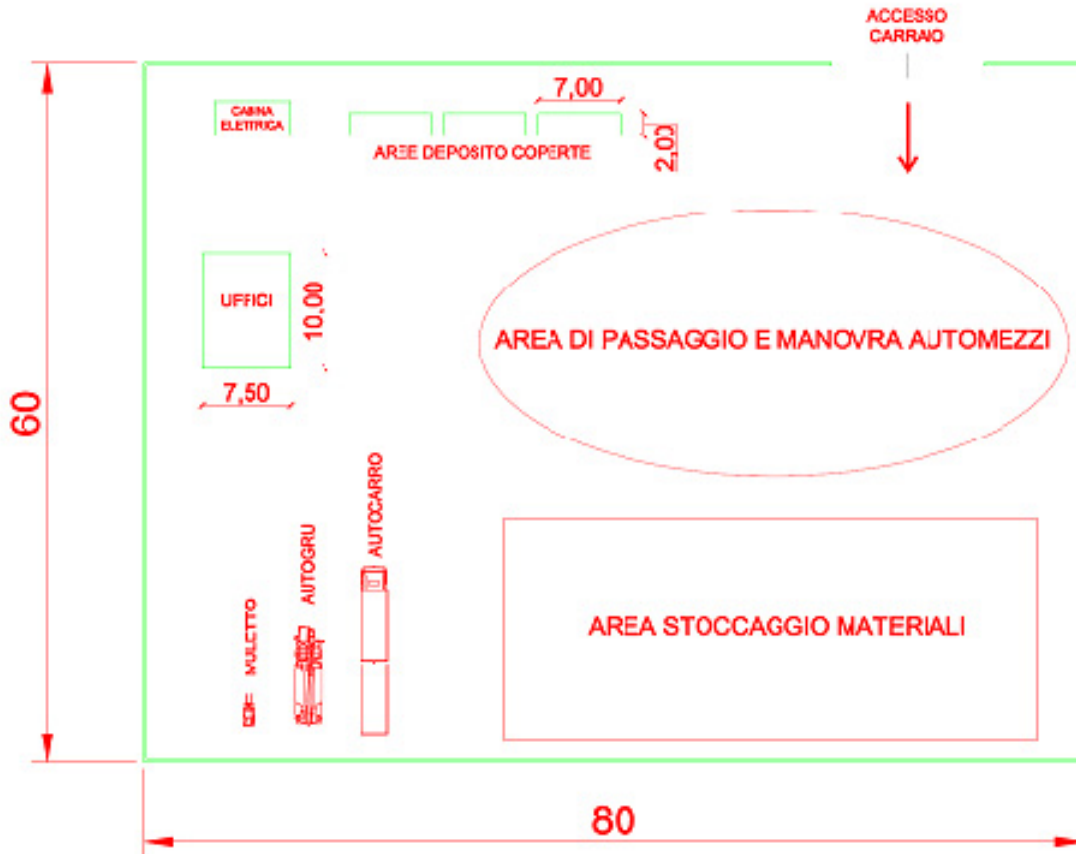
Planimetria dell'area centrale di cantiere - misure indicative
